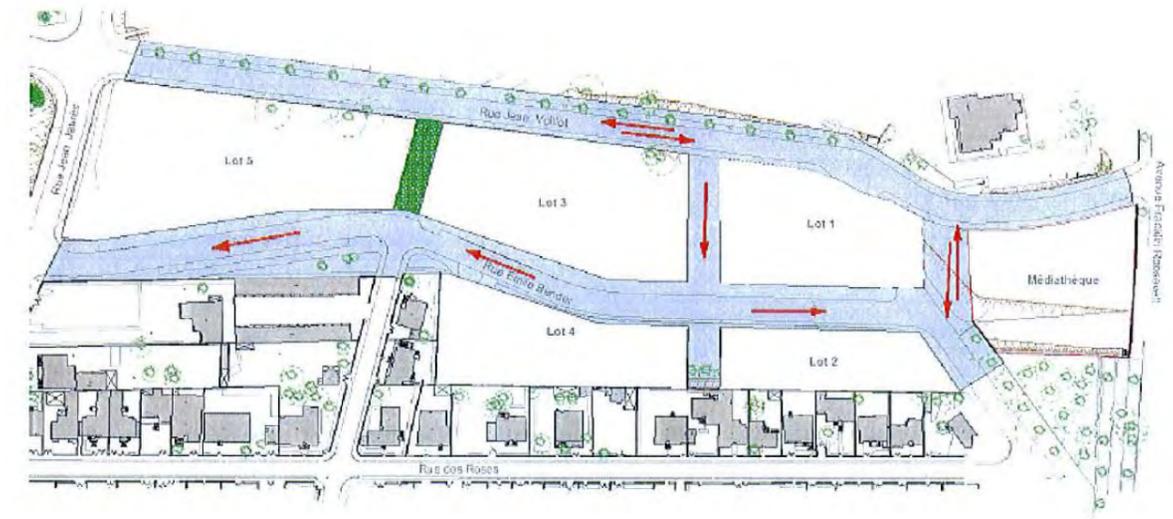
Plan et coupe d'aménagement du projet Parilly Nord
